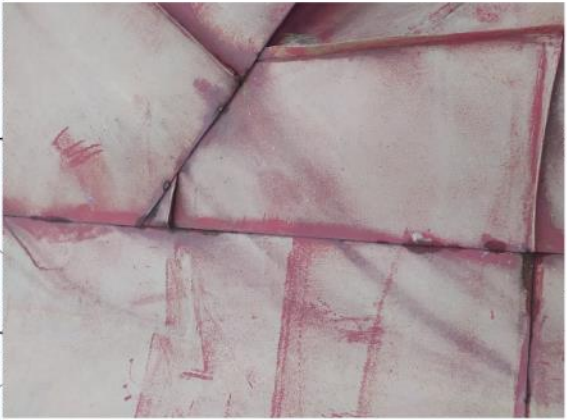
Следы коррозии металла (очаги ржавчины). Отслоение красочного слоя окрытия кровли.
